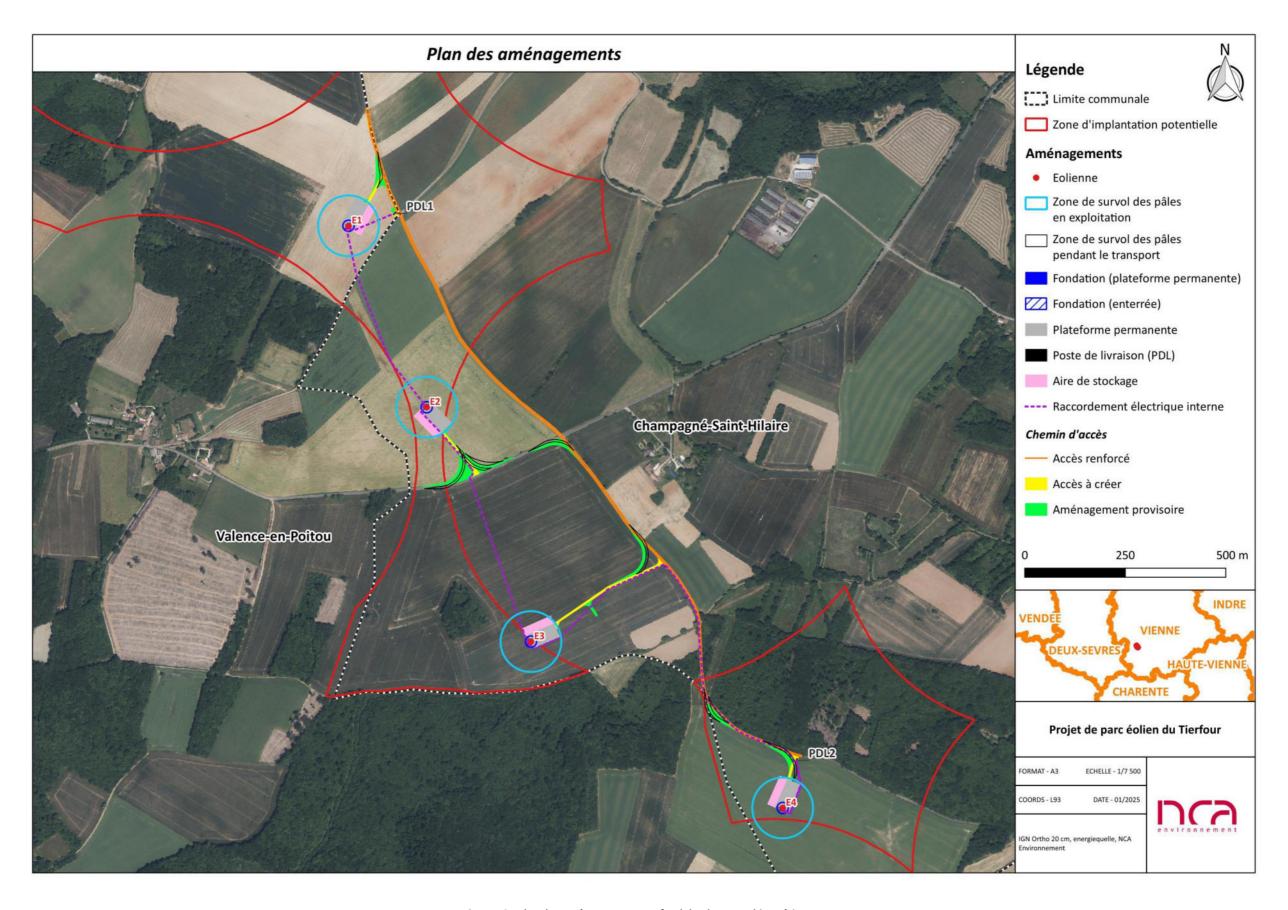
Plan des aménagements sur fond de photographies aériennes
